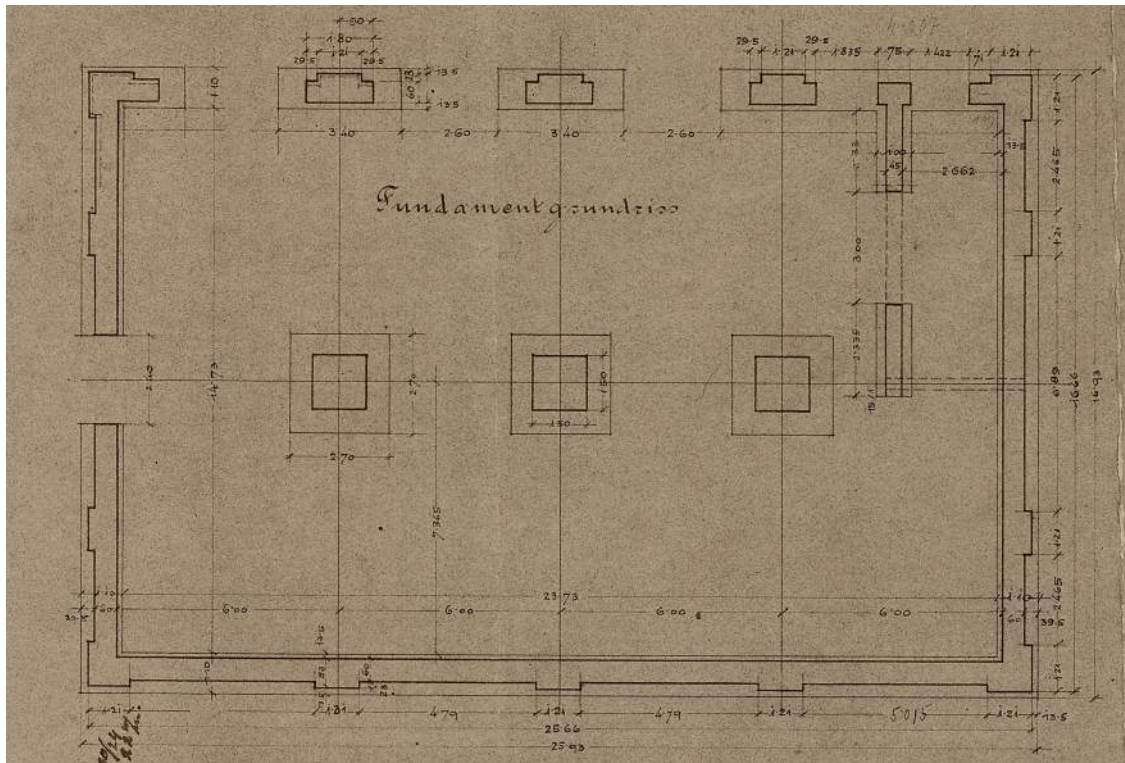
Fundamentgrundriss aus dem Originalplan von 1917
